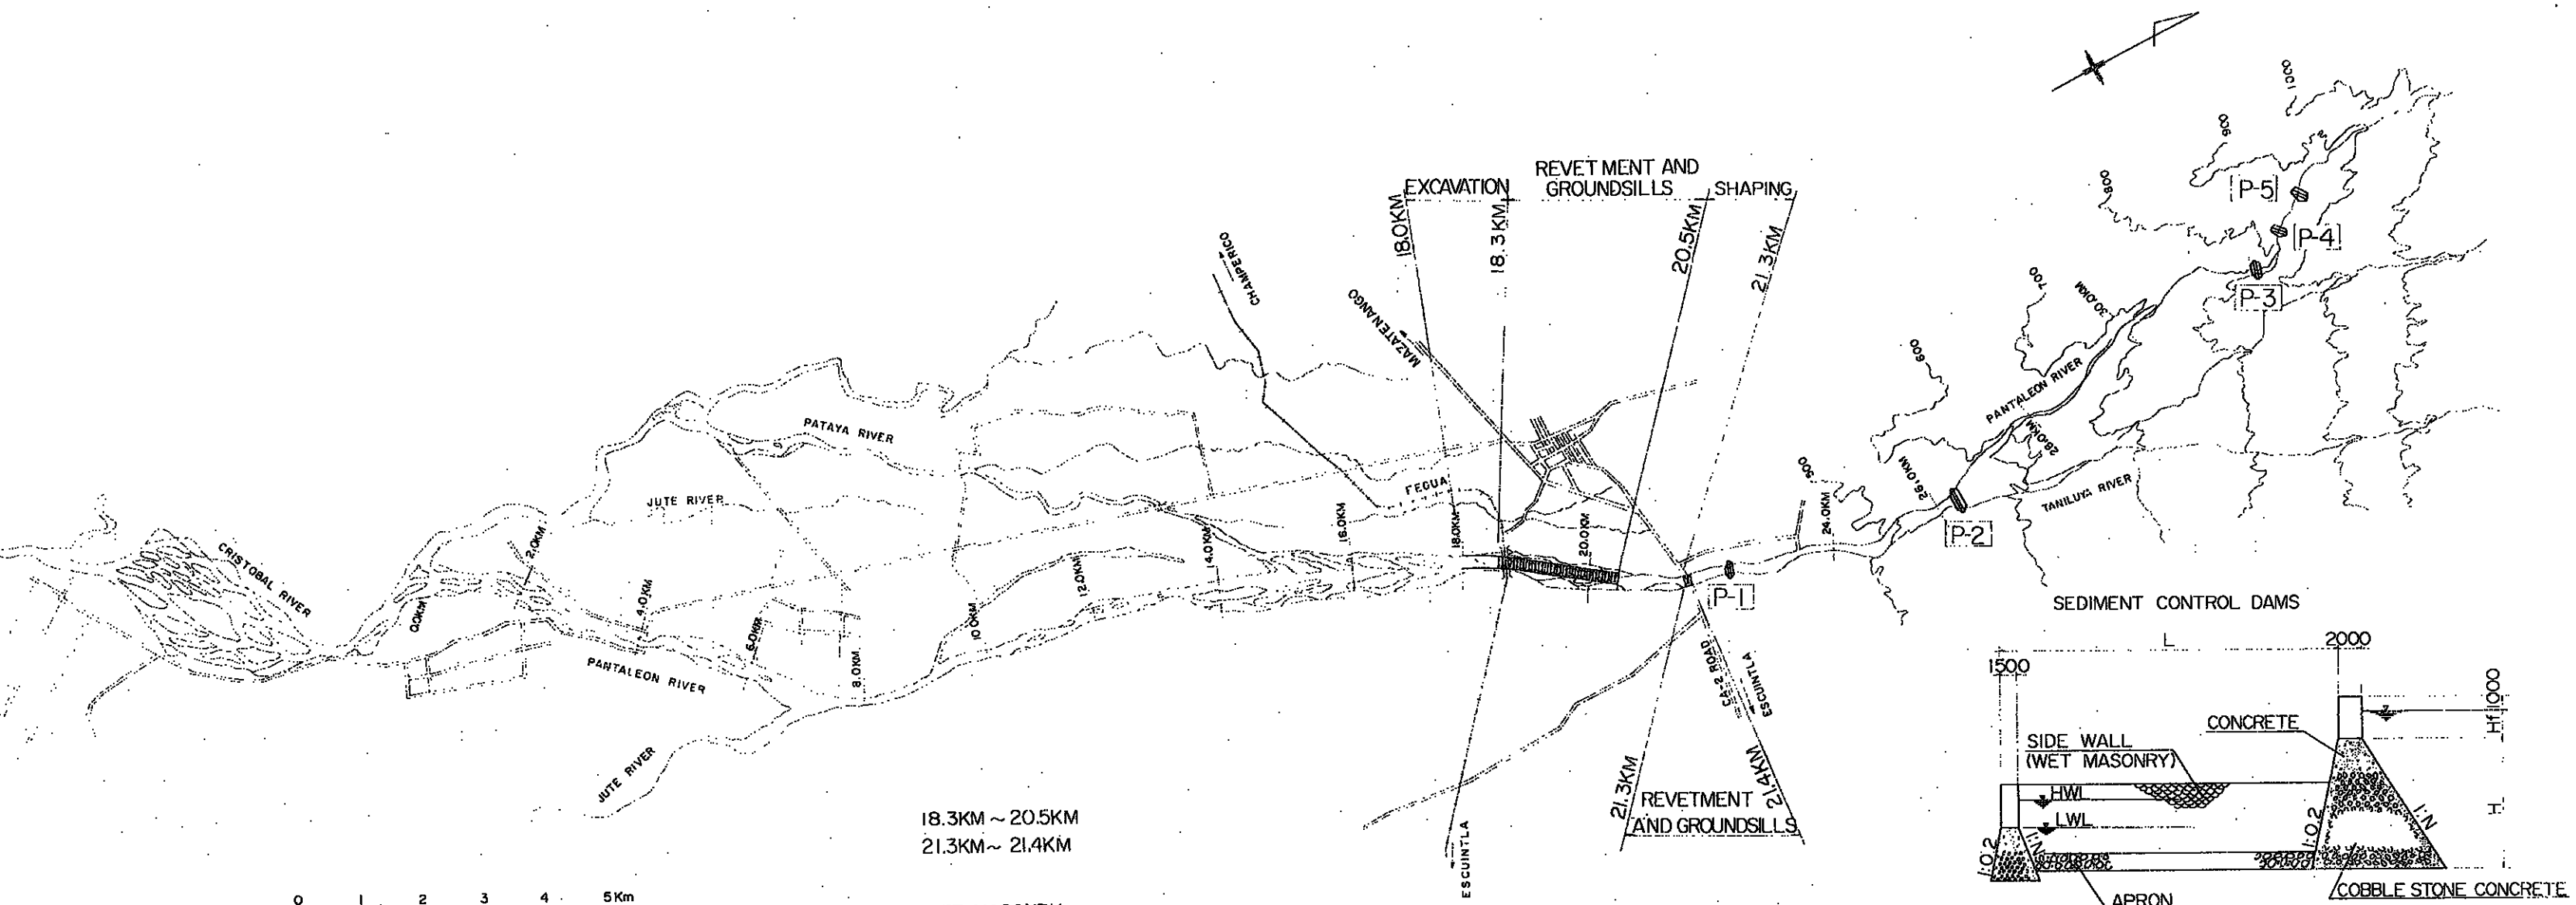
(1/2) 長期計画最適案平面図 (アチグァテ川)
